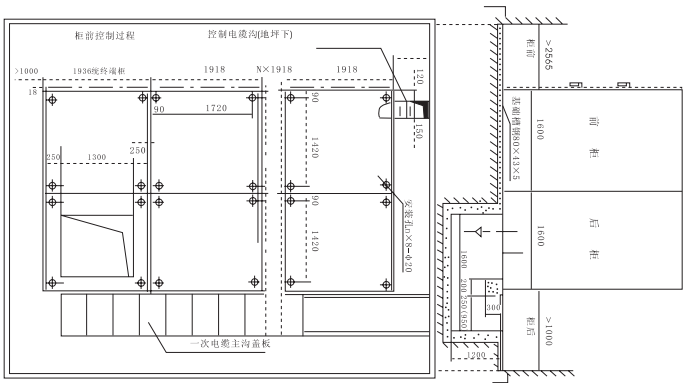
开关设备单例平面布置、基础槽钢埋放和一次电缆沟基础及二次控制电缆位置示意图
